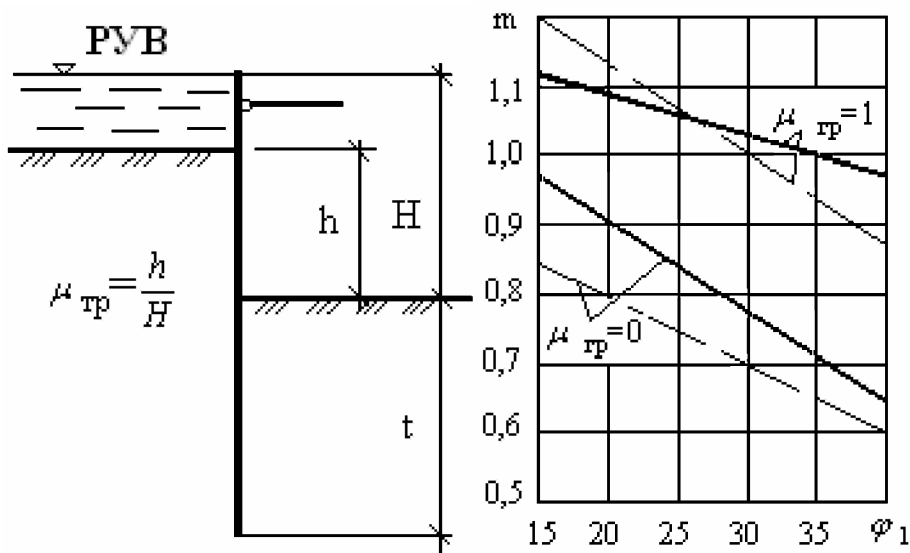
График для определения коэффициента $m = \gamma_c / \gamma_n$ (формула 7.2) для шпунтового ограждения на открытом водотоке (пунктирная линия дана для стенки с двумя и более ярусами креплений, сплошная – с одним ярусом)
